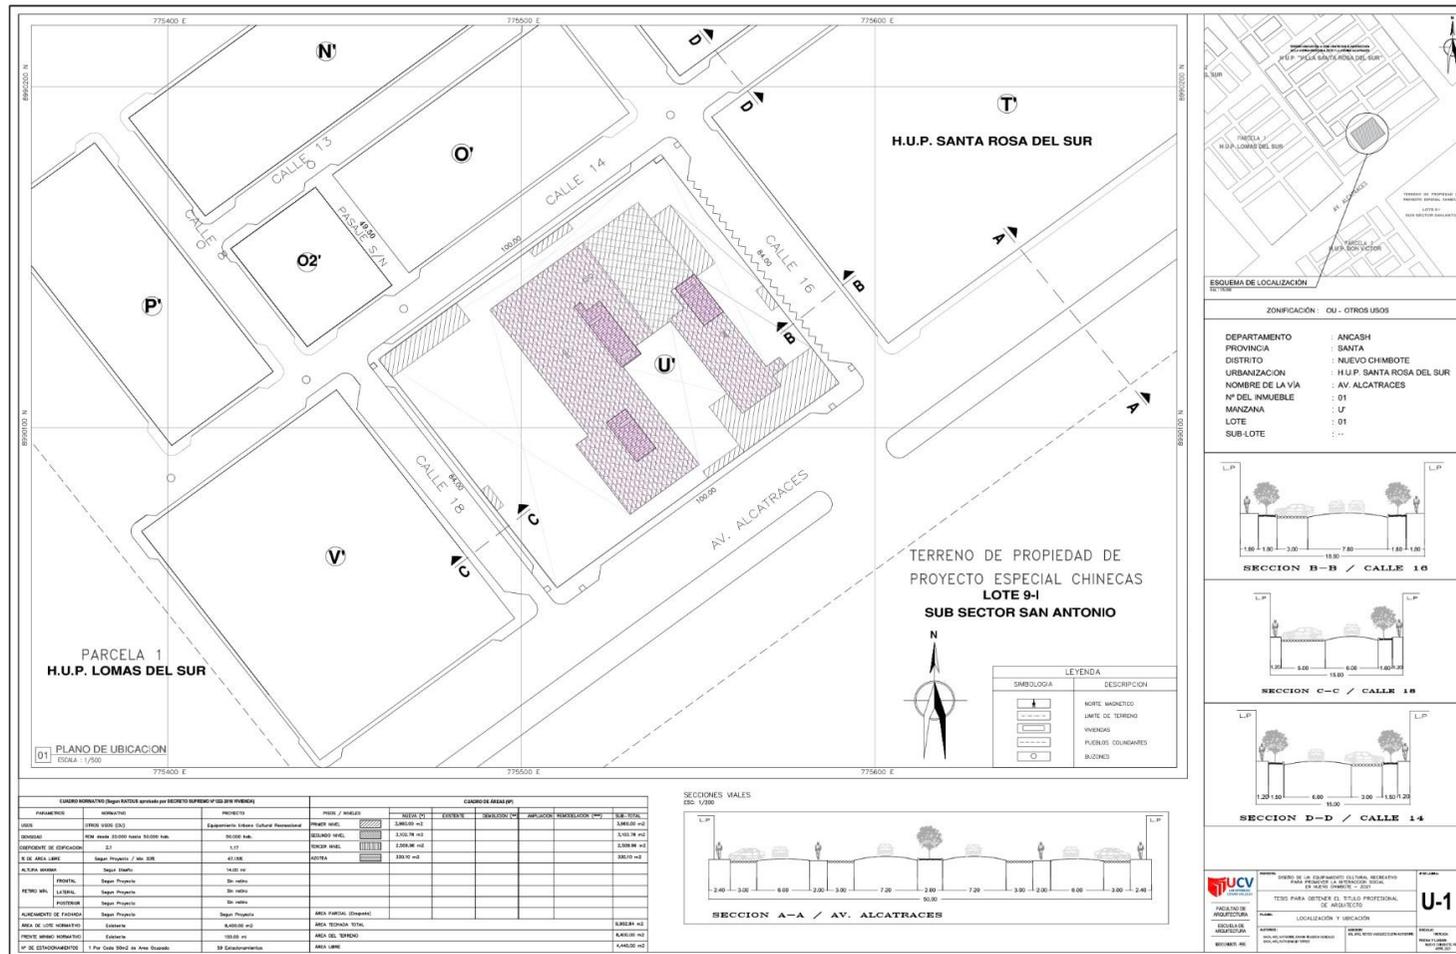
Plano de Ubicación y Localización (Norma GE. 020 artículo 8)
